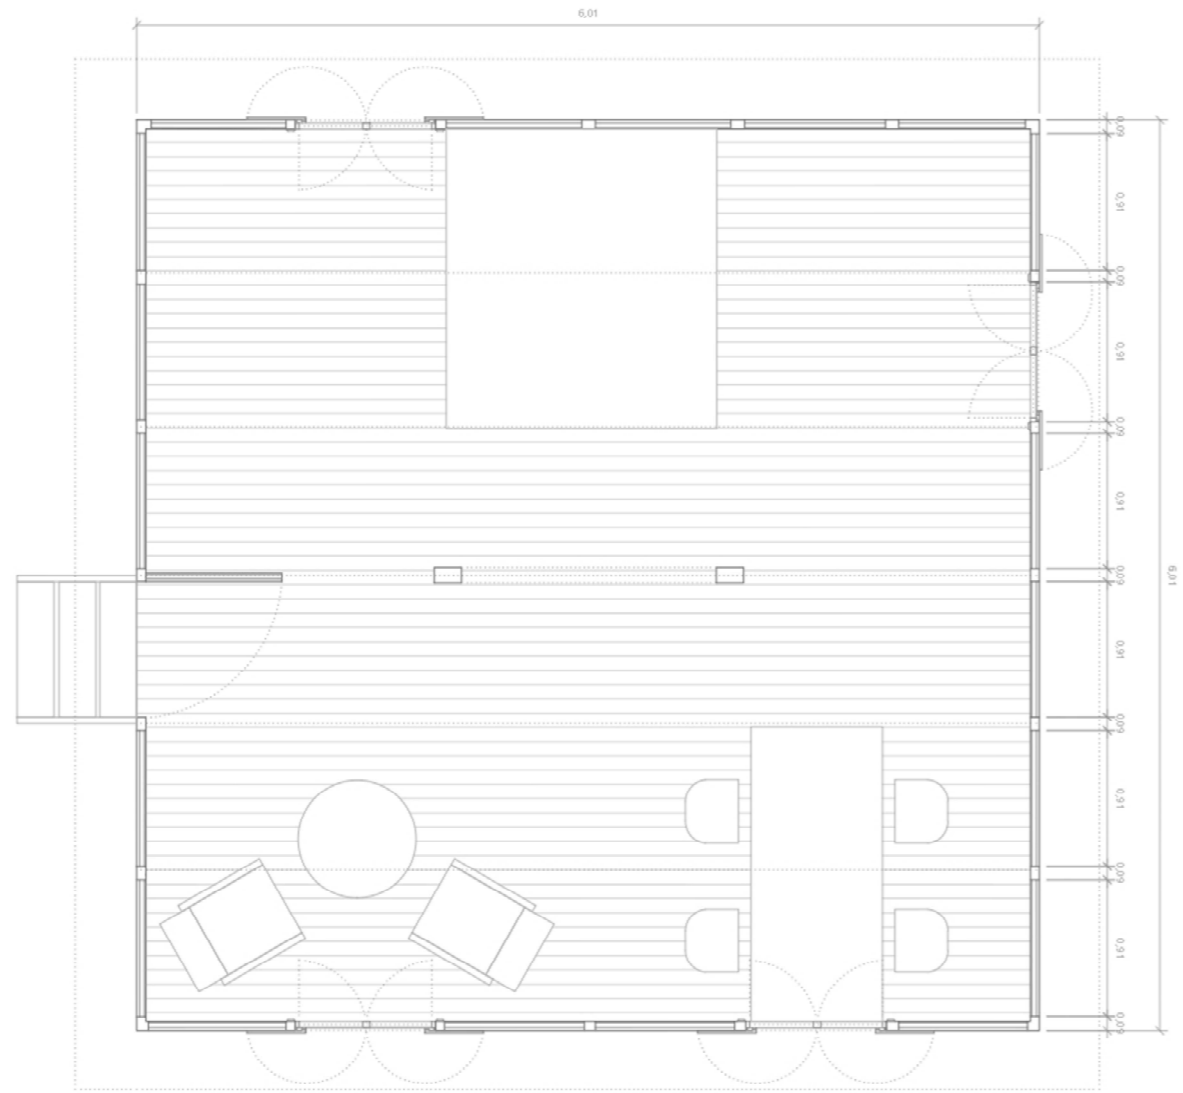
Planta casa desmontable 6x6. E:1/50. Elaboración propia.
